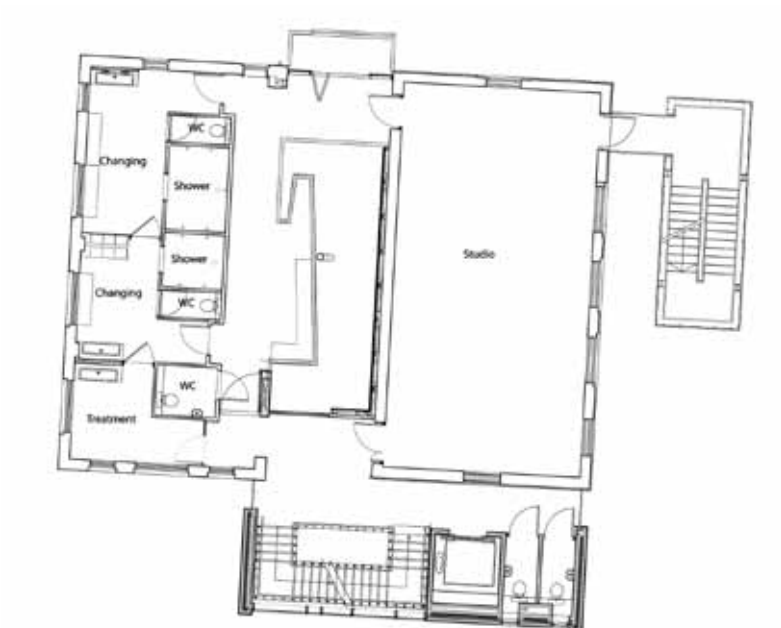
Grundriss © SarahWigglesworth Architects
